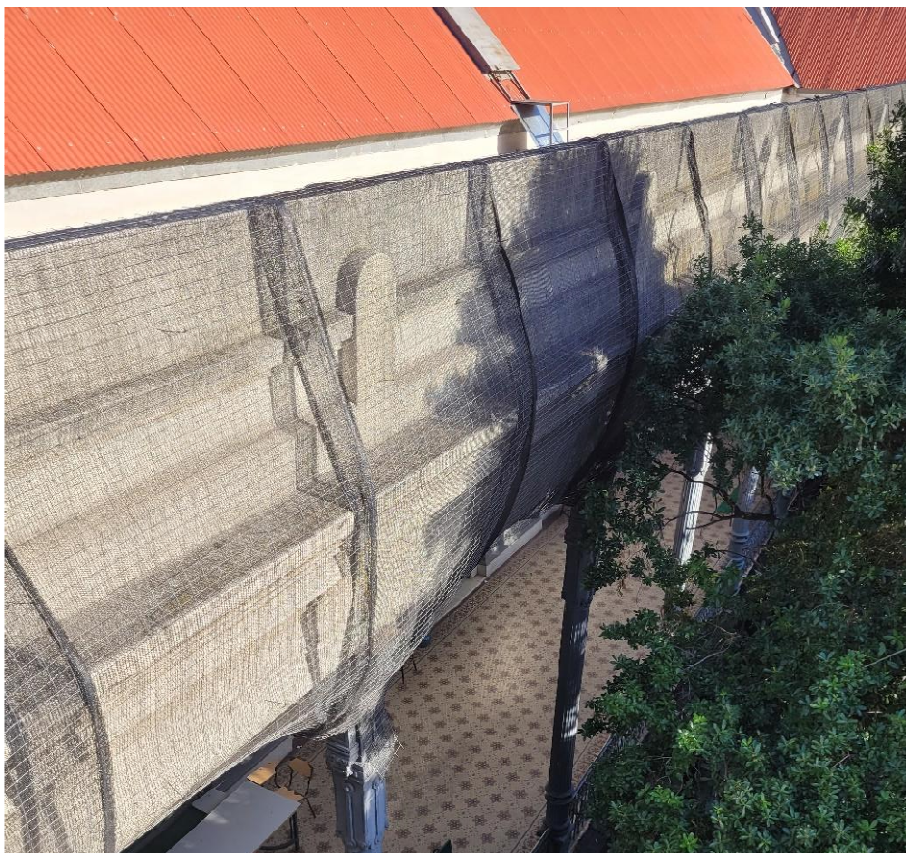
Grieta horizontal en pretil superior de galería izquierda
